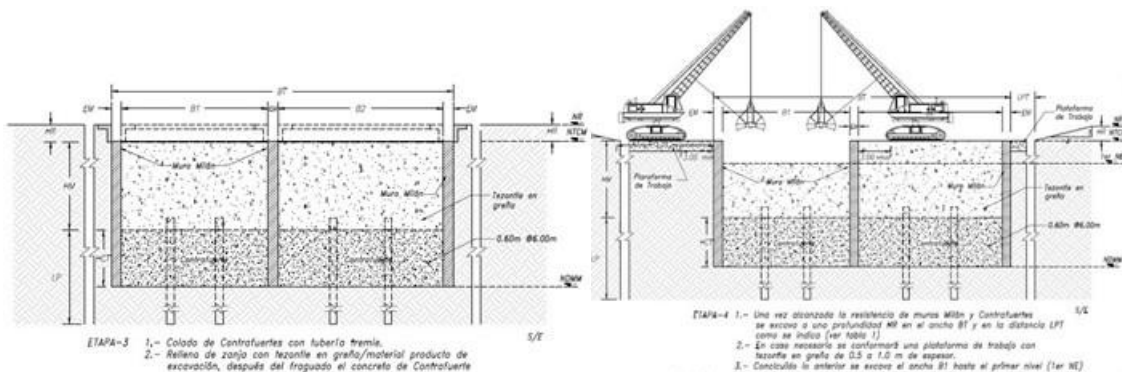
Procedimiento constructivo Túnel GSE de sección cerrada etapa 3 y 4 (Plano constructivo BT 86 CRS XXXTE 211).
